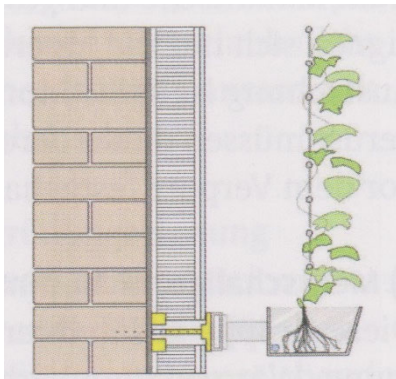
Konstruktion von troggebundener Begrünung bei transparenter Wärmedämmung
